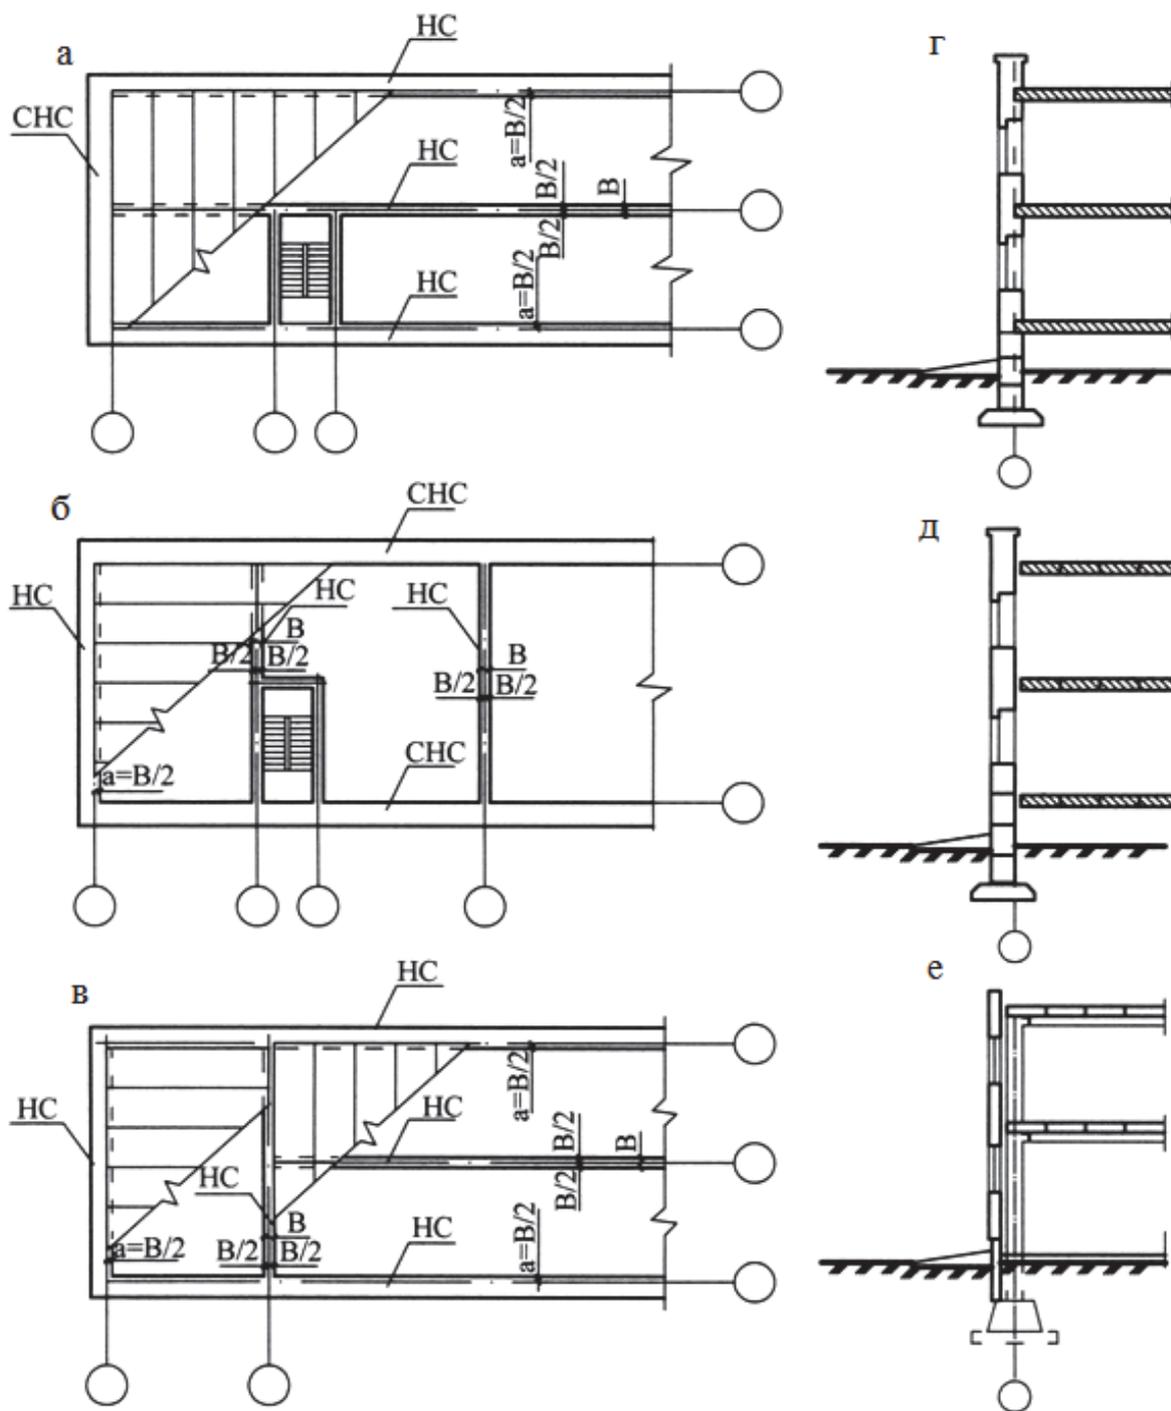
Конструктивная схема здания и типы наружных стен жилого здания:
